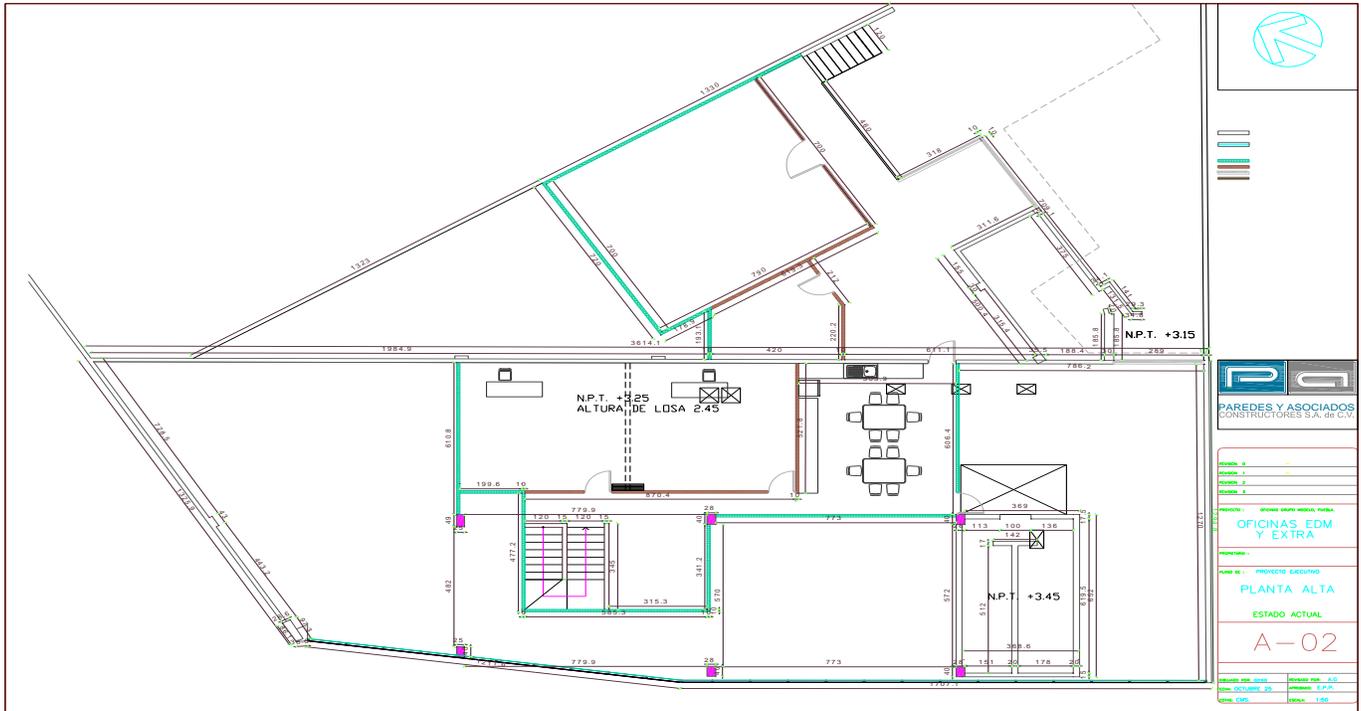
PLANTA ALTA: Plano arquitectónico donde podemos apreciar, la tienda escuela, oficinas gerenciales y espacios muertos del proyecto.
